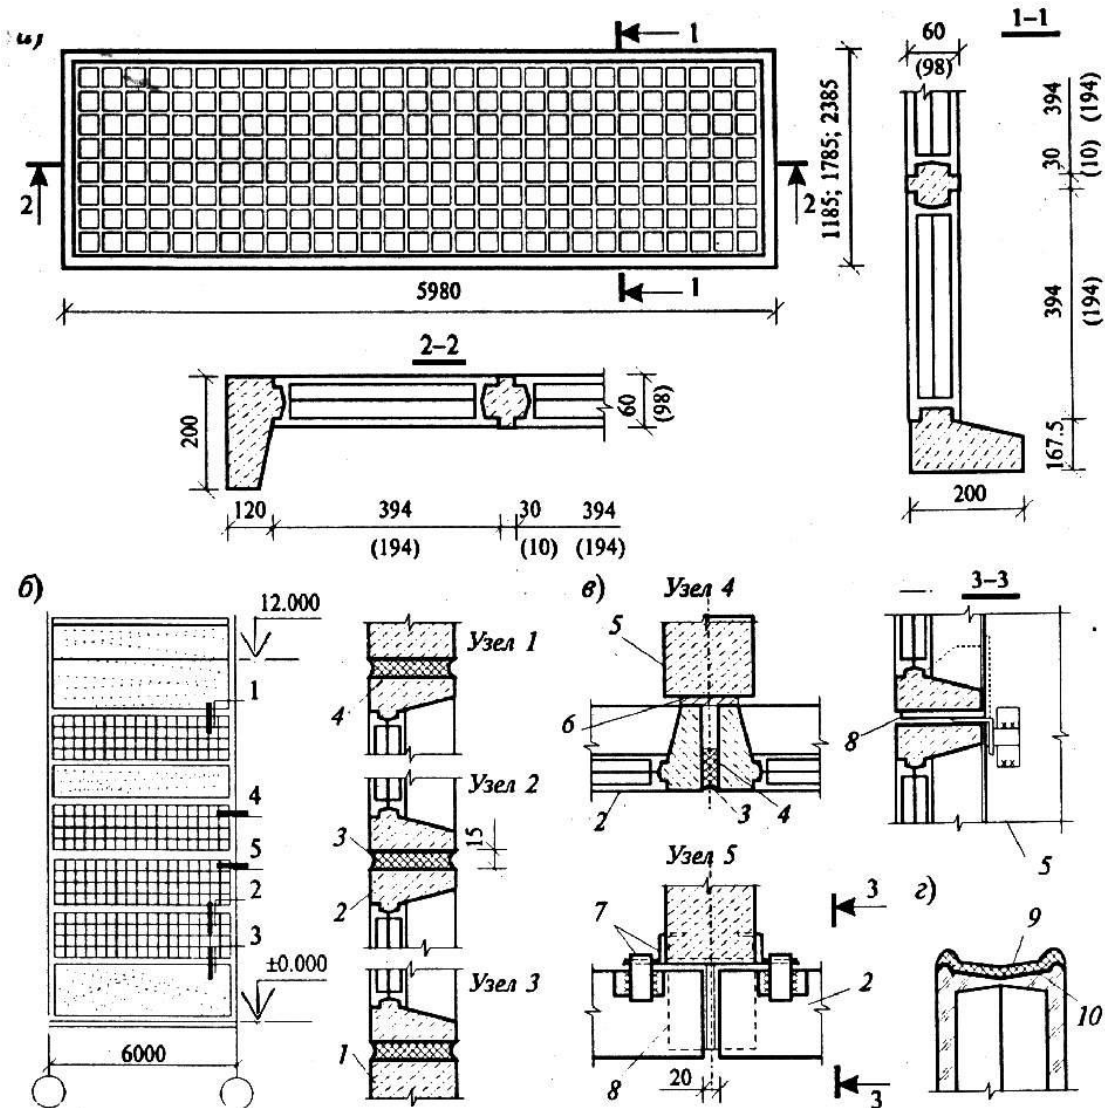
Стекложелезобетонные оконные панели:
